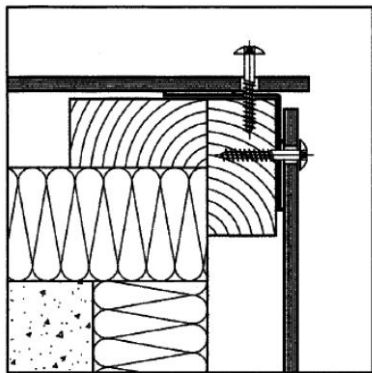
Angle intérieur (vue en coupe horizontale)
